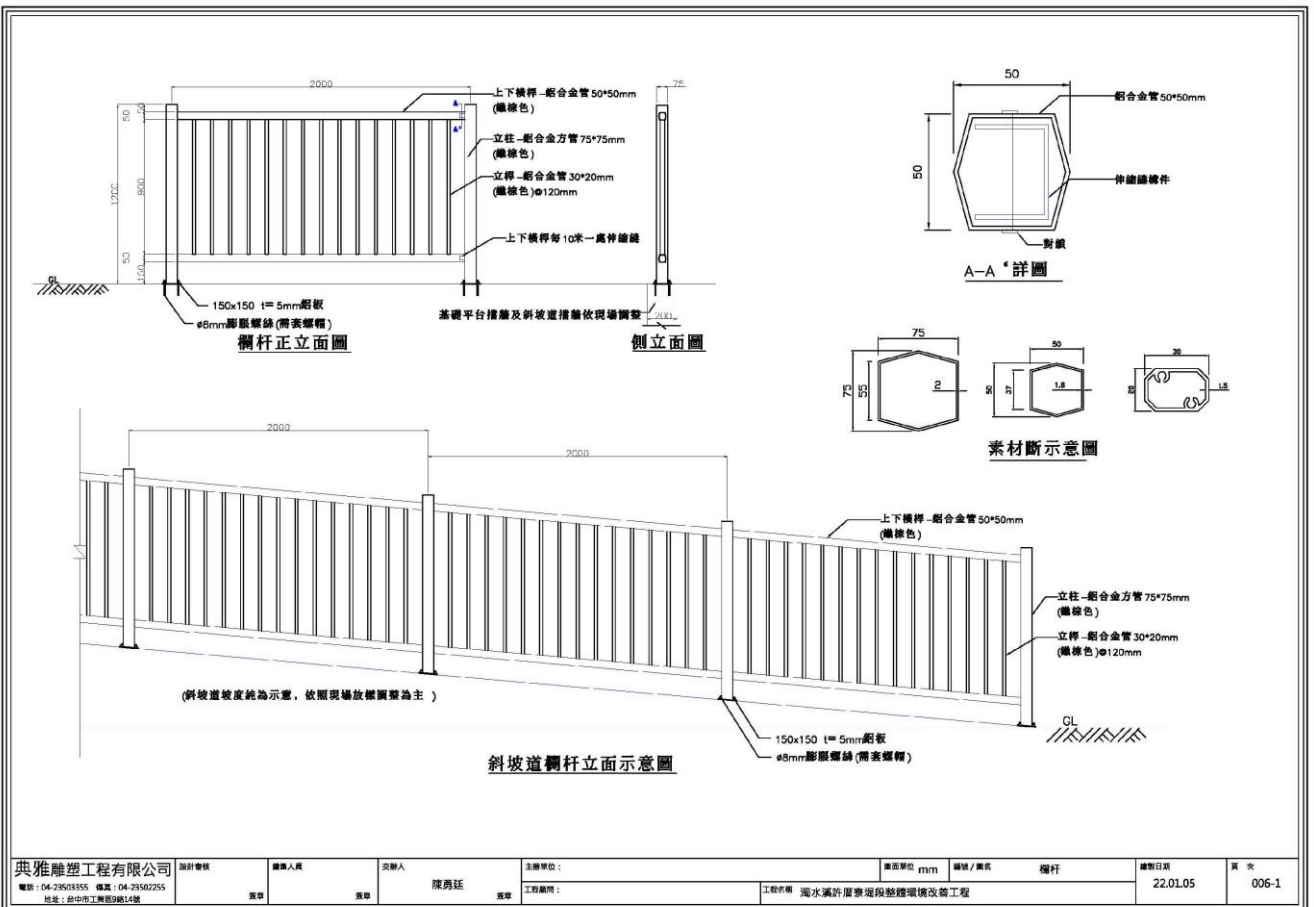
景觀設施工程欄杆施工圖(1/2)
